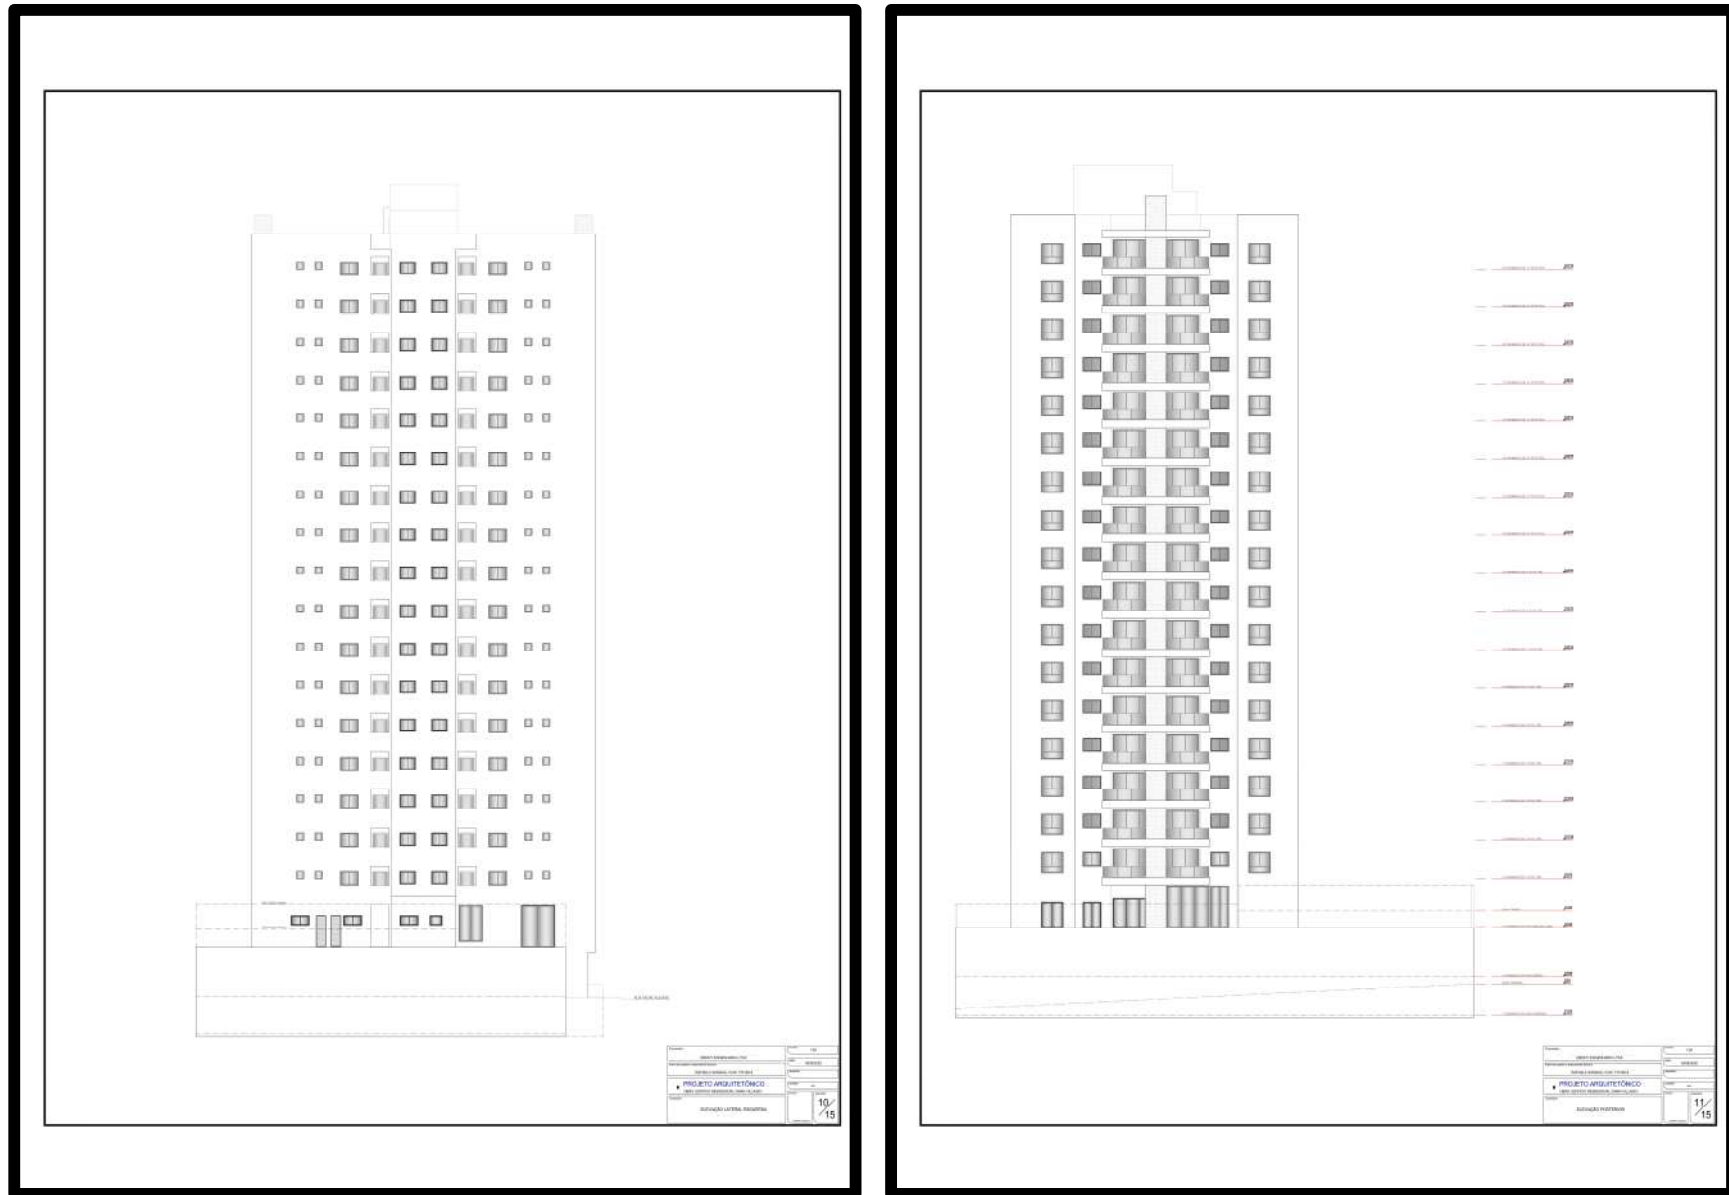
Elevações 03 e 04. Fonte Construtora Merhy (2020).
